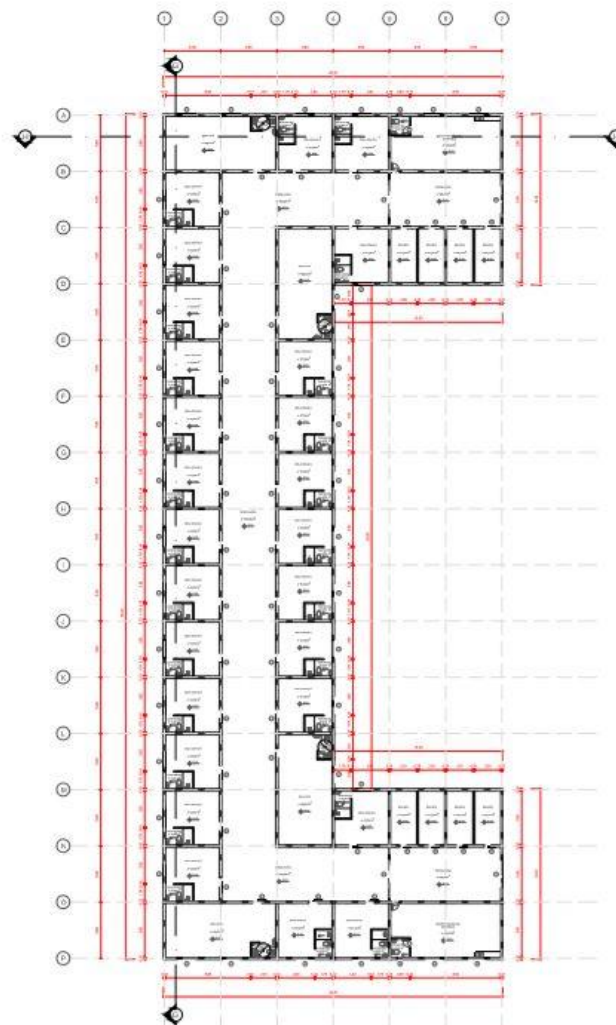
Planta Técnica – Fonte: Acervo Próprio
